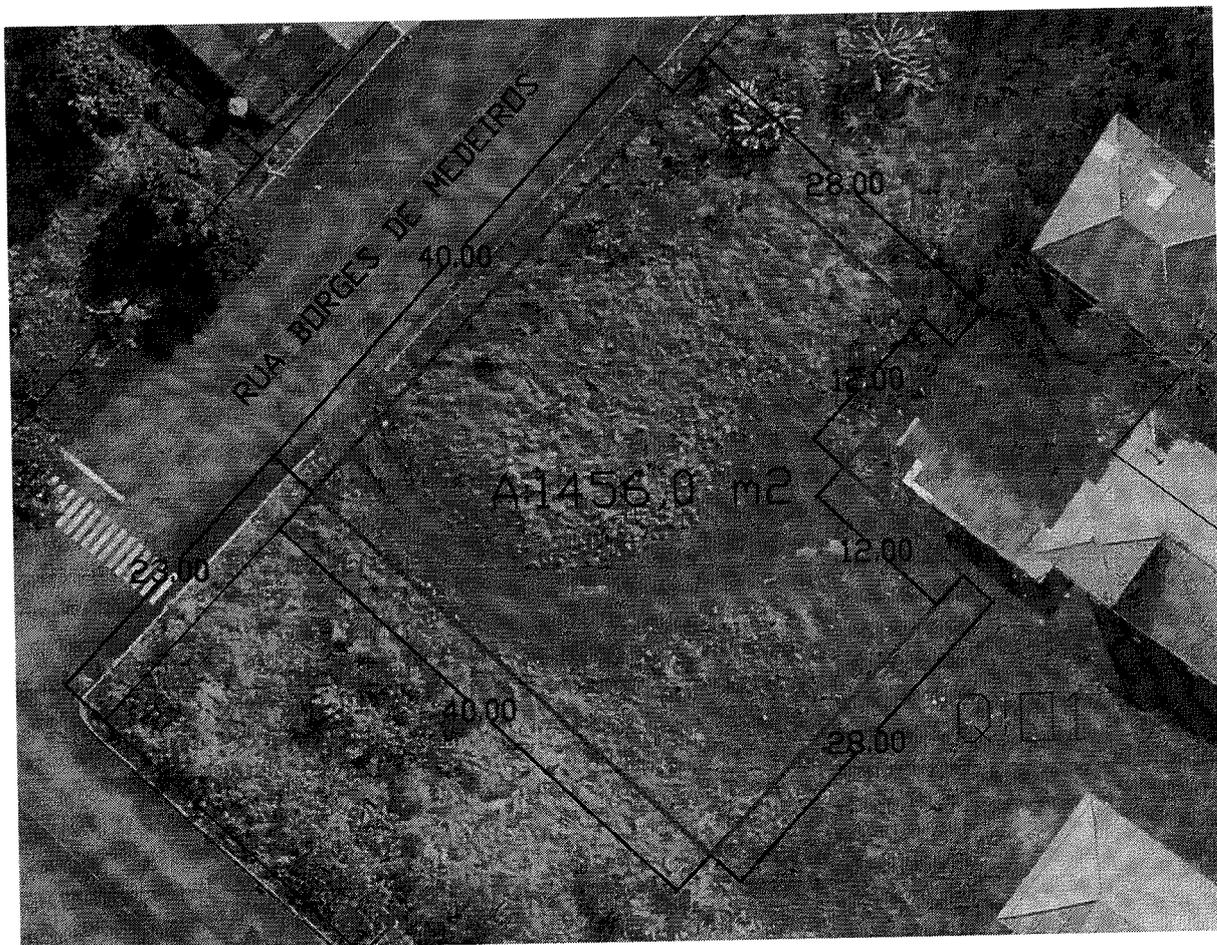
Delimitação do terreno destinado à construção da UBS, demarcado em vermelho, localizado na Rua Borges de Medeiros.
